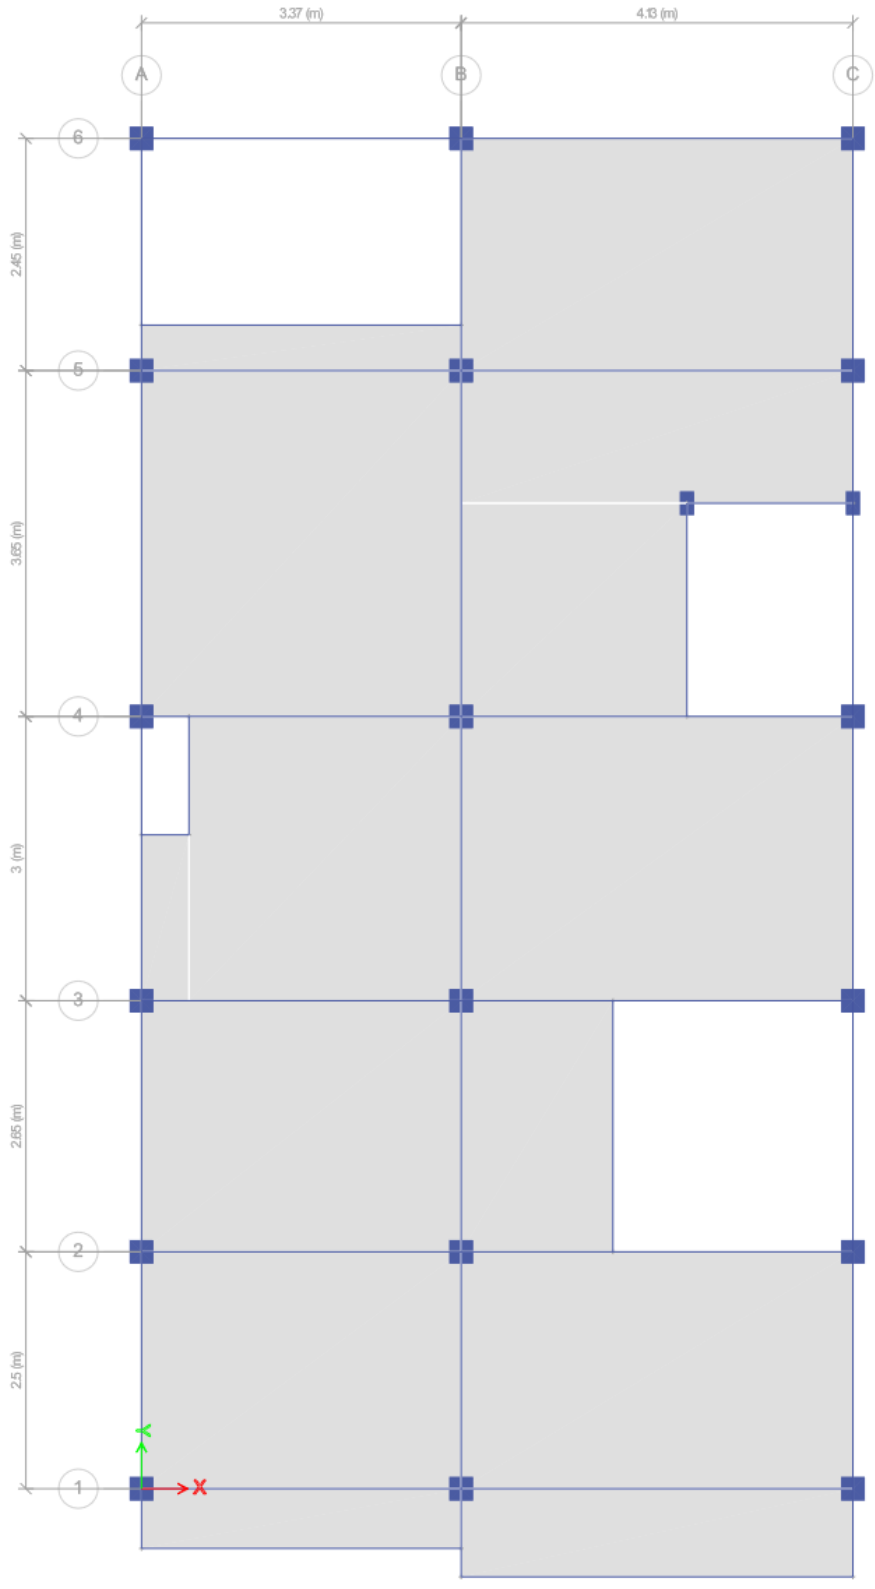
Vista en planta de la estructura de concreto armado Modelo de análisis.
